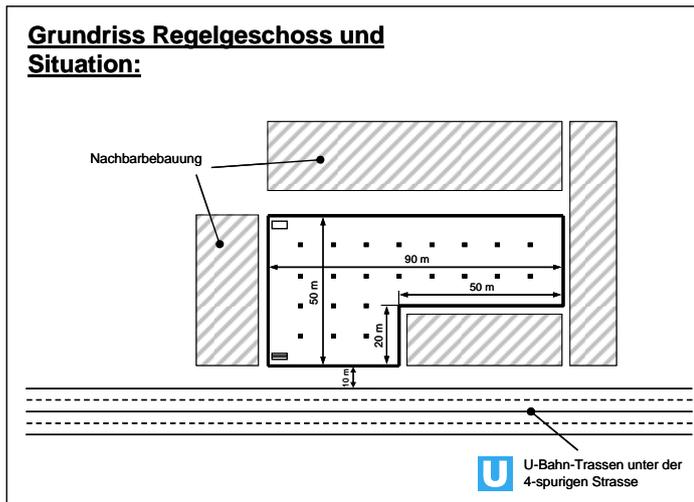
Grundriss Regelgeschoss und Situation
